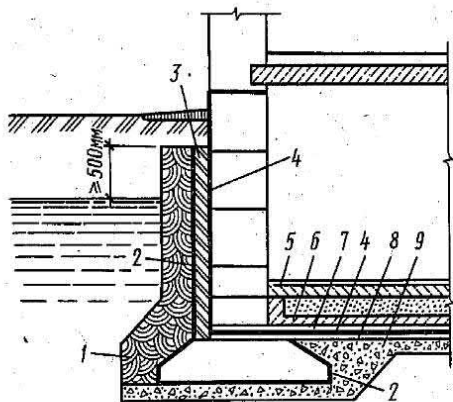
Изоляция фундаментов от агрессивных подземных вод:
